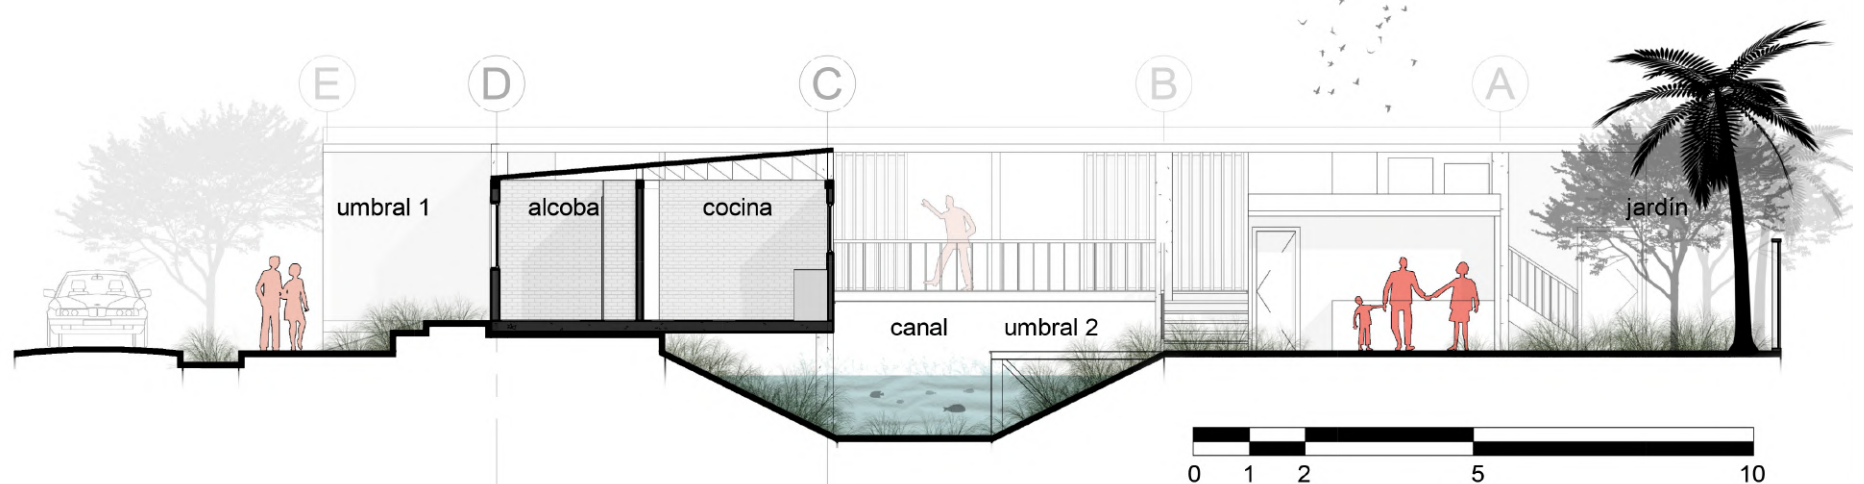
Sección arquitectónica de la propuesta para vivienda sobre el canal. Elaboración propia.
